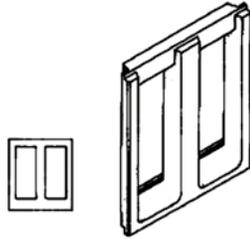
Detalle de Losa Lex para cerramiento horizontal
